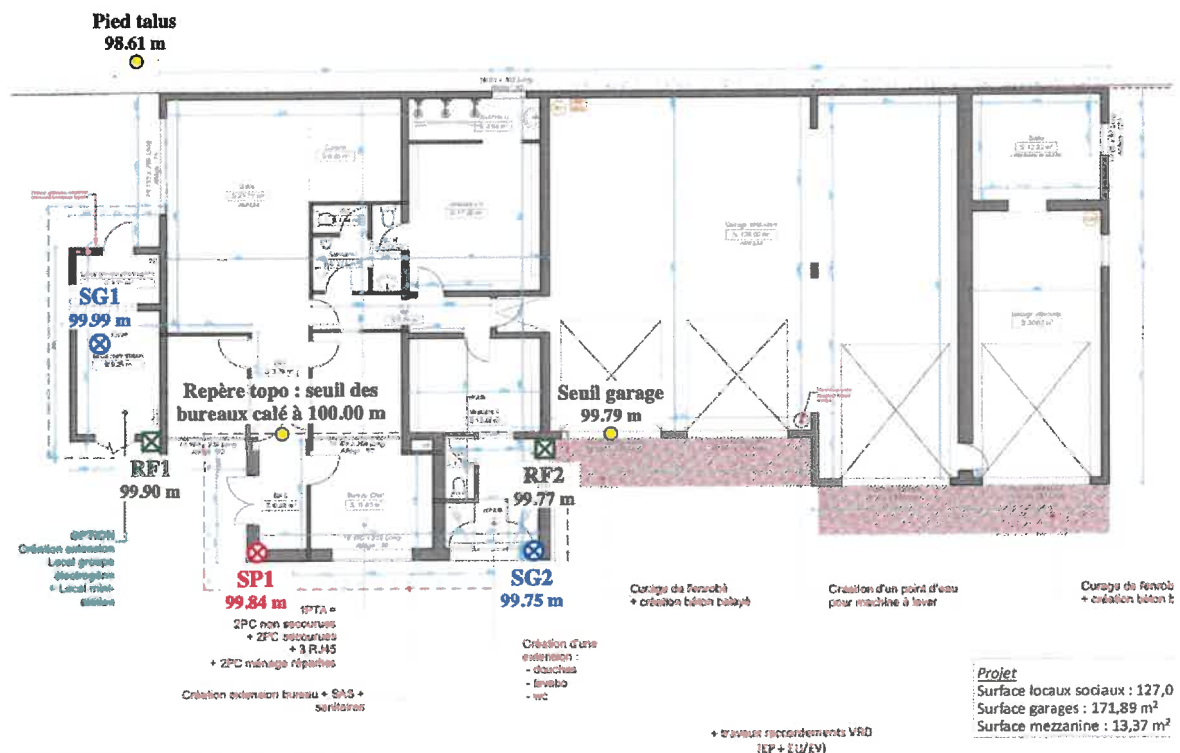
Plan d'implantation des fouilles de reconnaissance des fondations existantes – Extrait du rapport DIAG-SOL.
